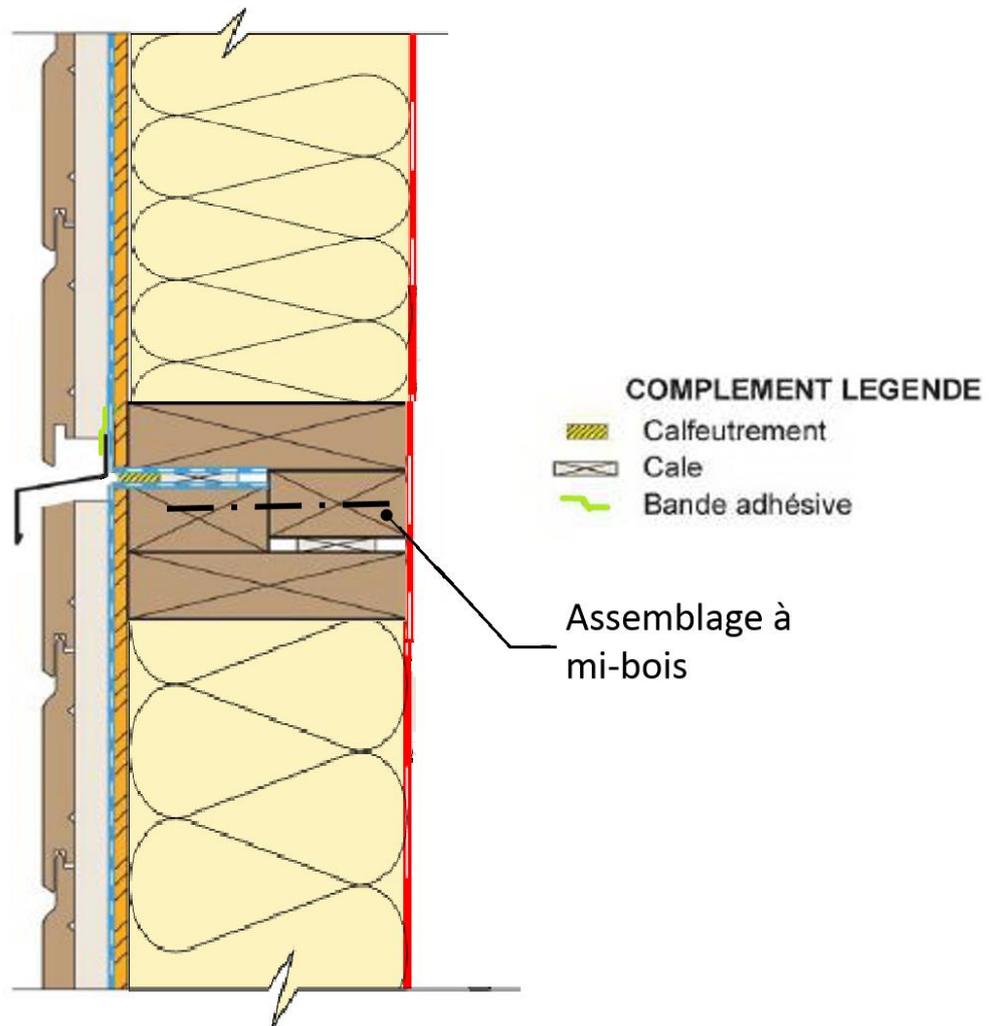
Exemple de positionnement du calfeutrement dans le plan du pare-pluie et assemblage à mi-bois dans le cas d'une liaison entre murs au droit d'un plancher (coupe verticale)
